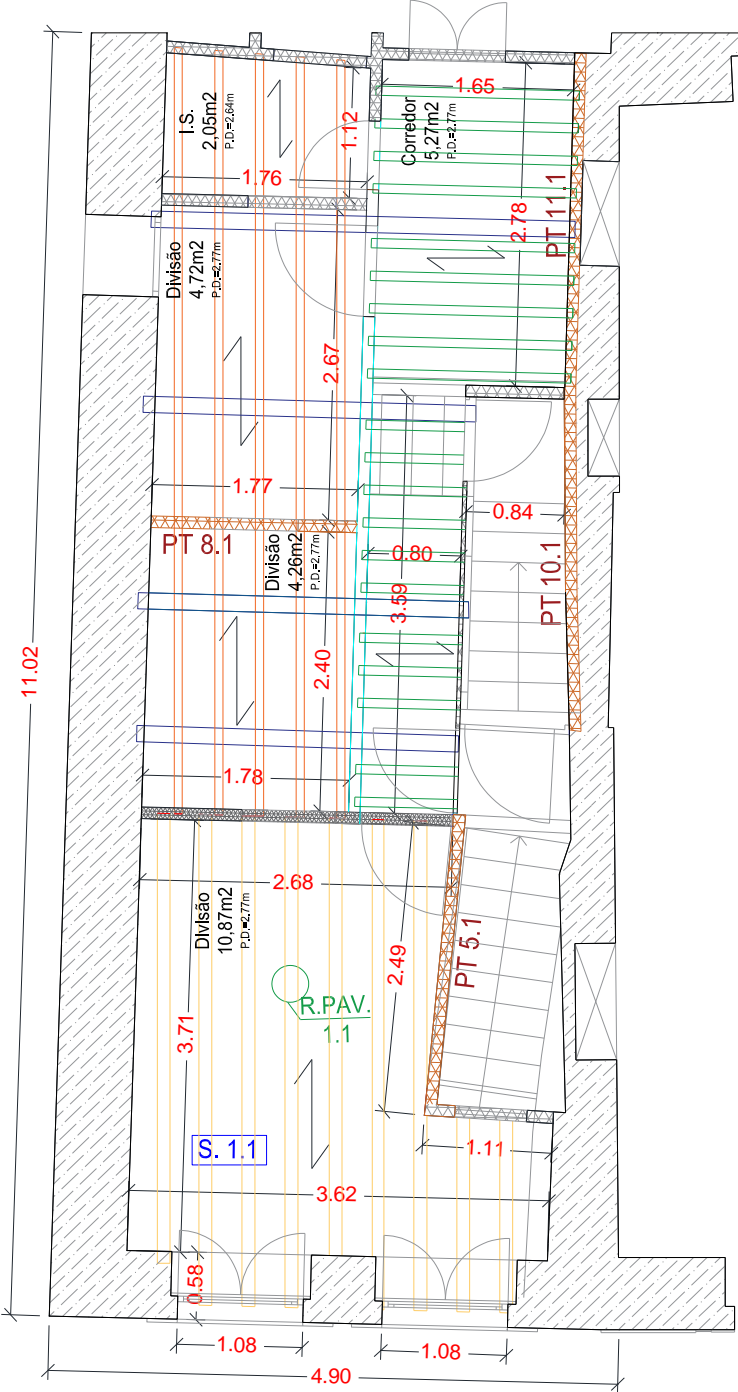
Disposição das vigas no pavimento do Piso 3
